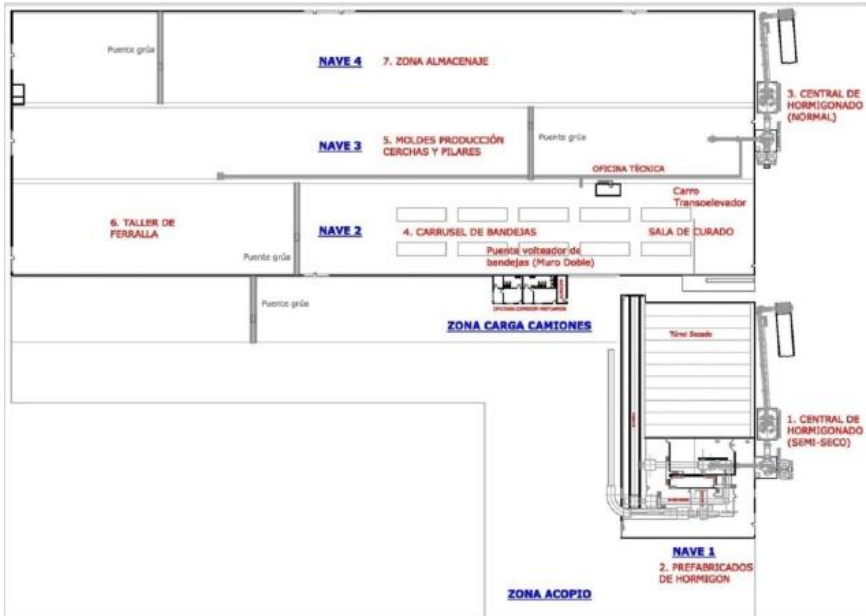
Planta esquema. www.prefabricadoscanal.com
